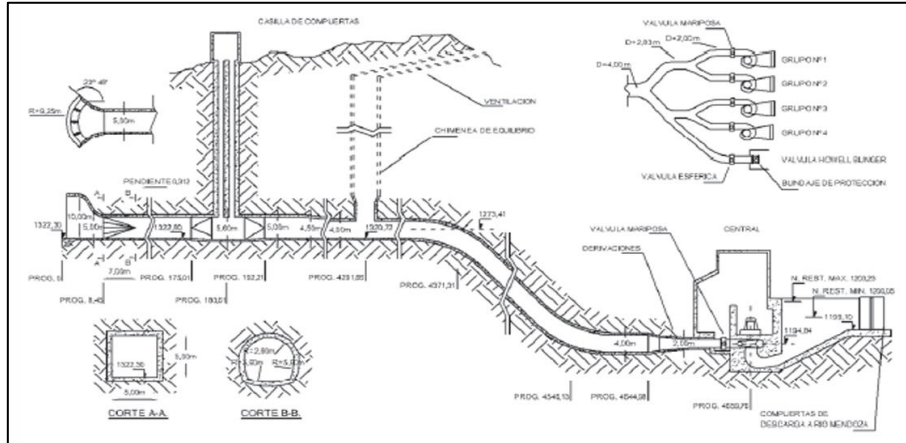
Corte esquemático de la Tubería Forzada a la Central Cacheuta.
